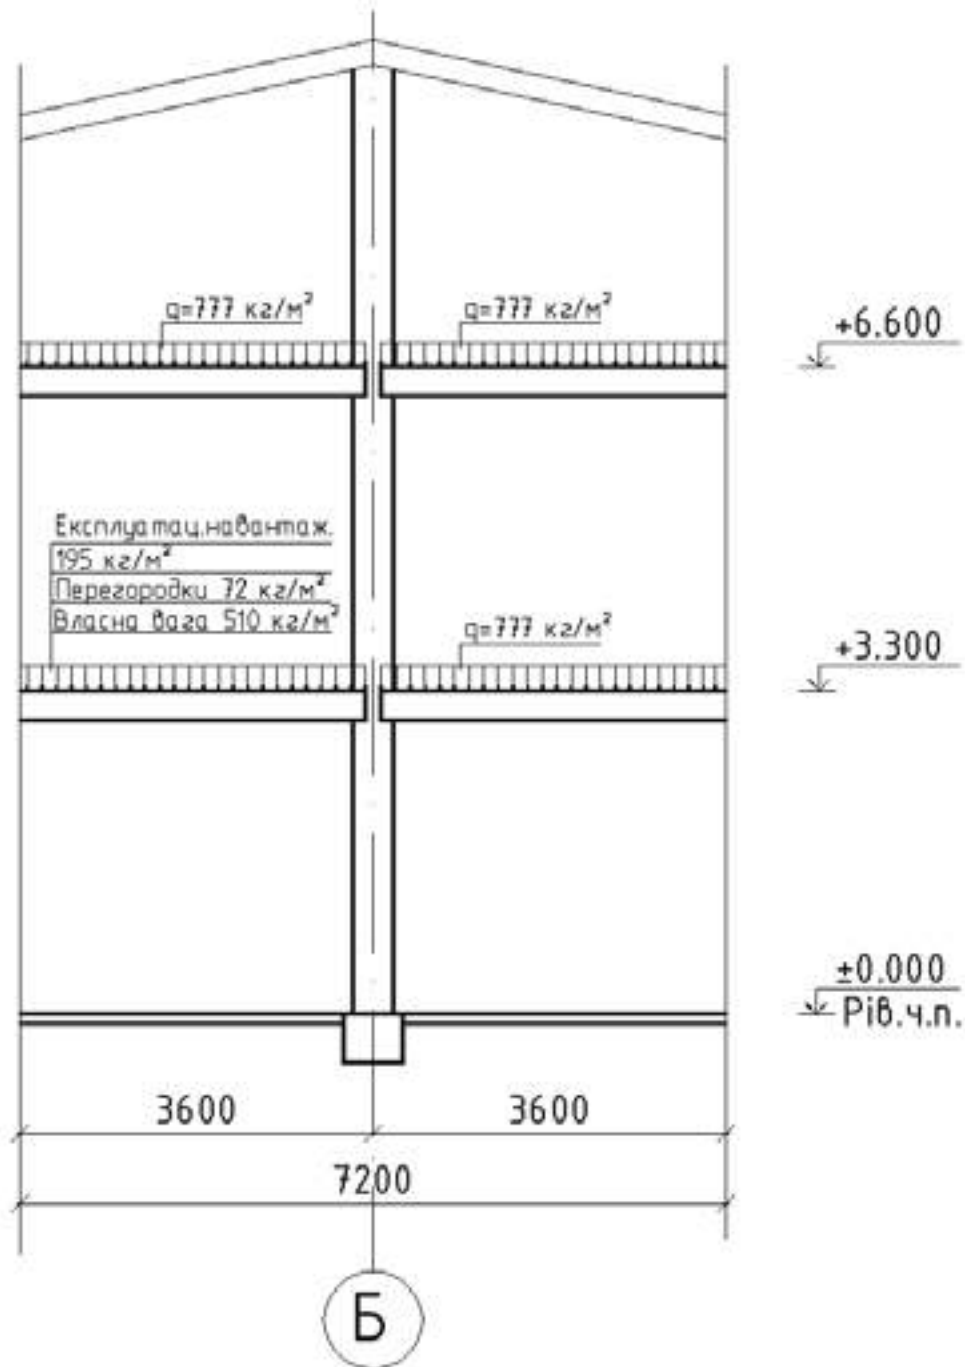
Схема навантажень середньої стіни 2-поверхового будинку з мансардою
